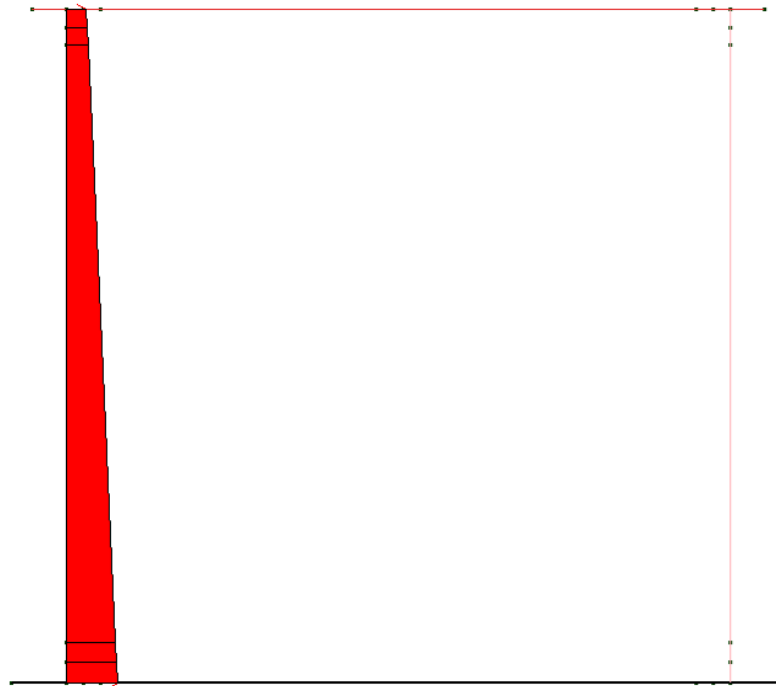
SPINTA ATTIVA DELLE TERRE SUL PIEDRITTO SINISTRO (CDC 5)
